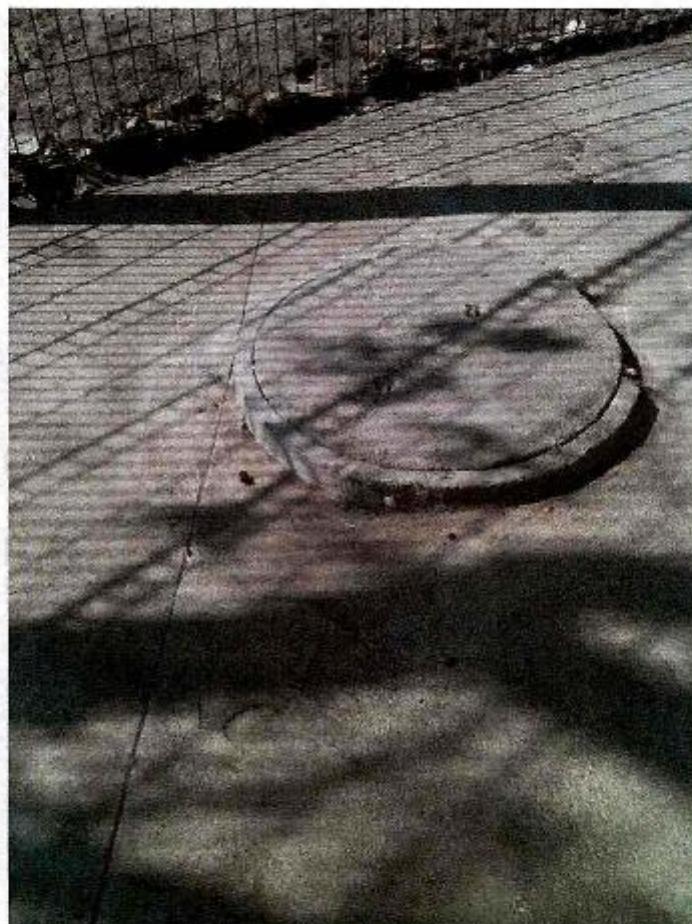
Tapa de cámara bajo el nivel del radier en acceso a baños sector sur.
